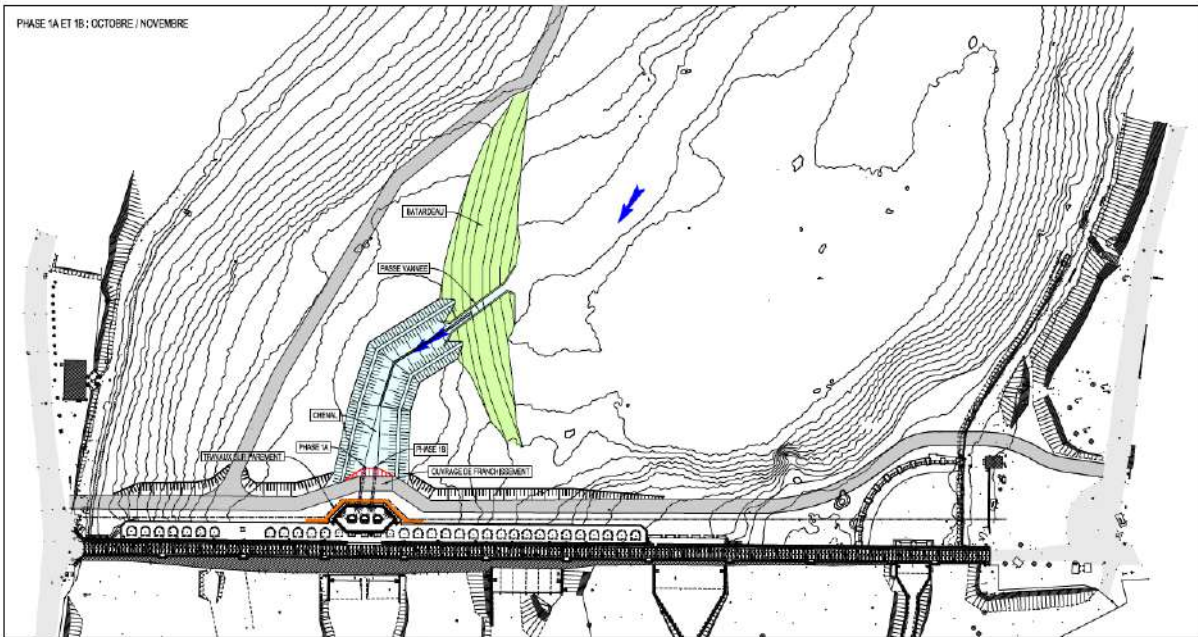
Plan du batardeau amont vanné et du chenal de liaison mis en place pour 2022
